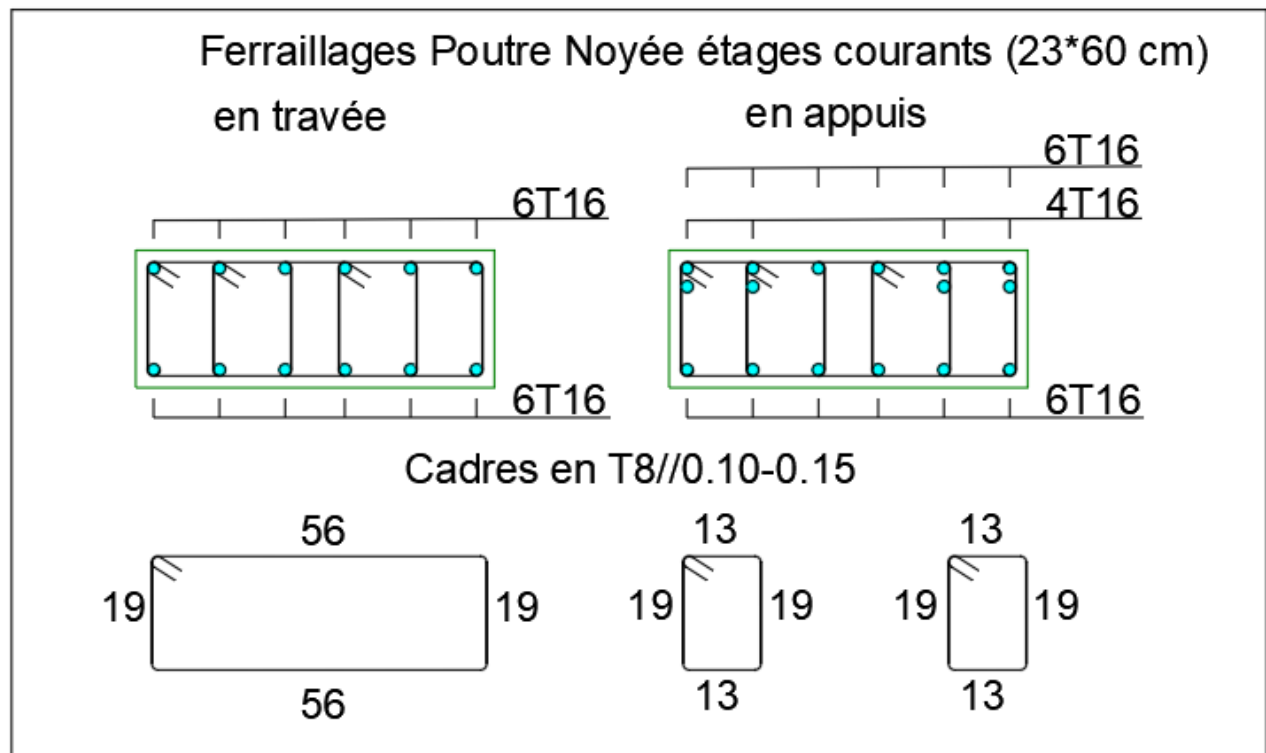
Ferraillages Poutre Noyée étages courants 23*60 cm.
